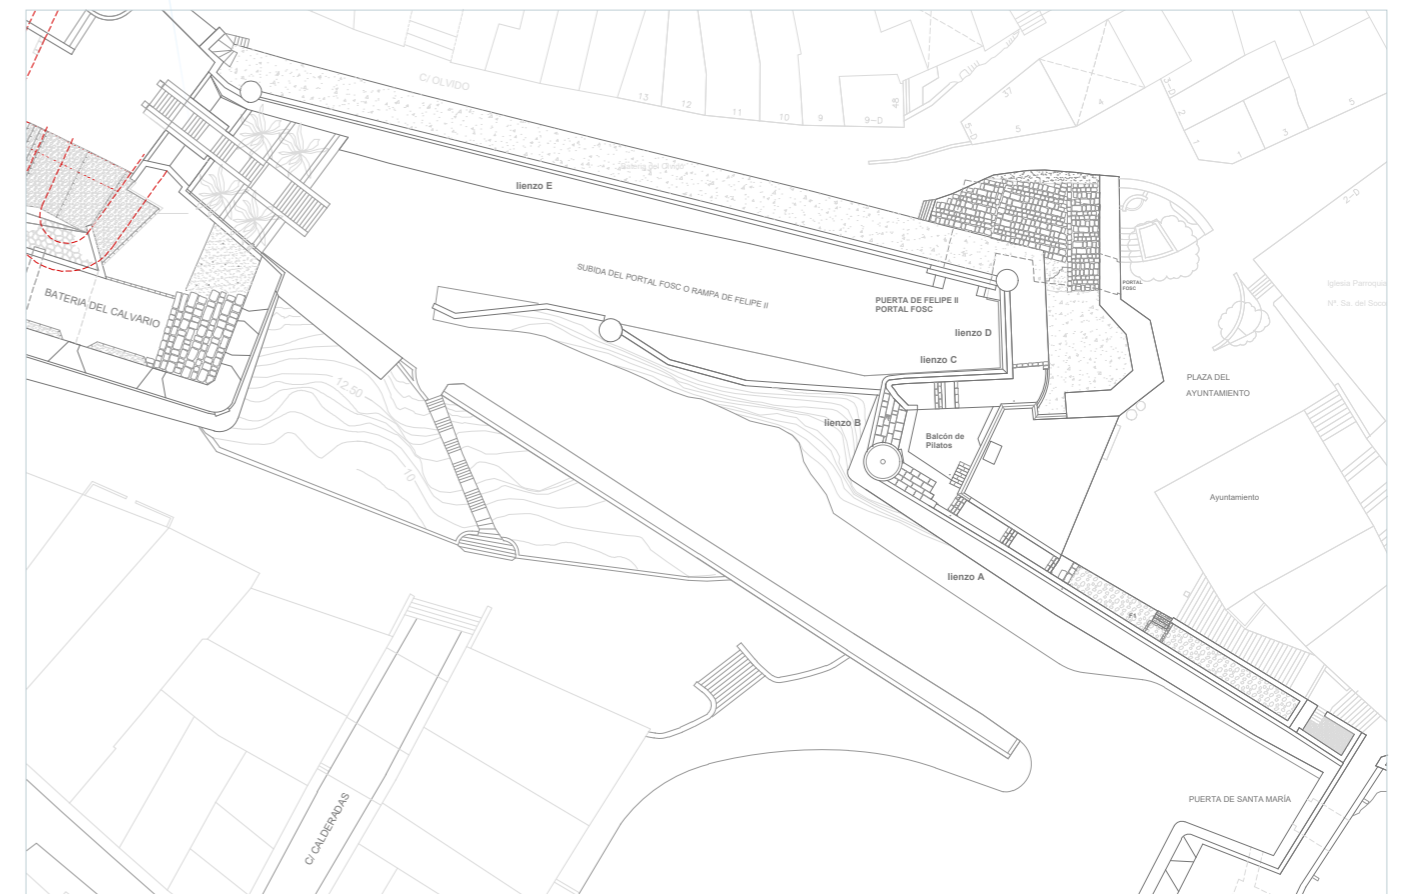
Planta del estado actual de la zona central. (MJB 2013).
